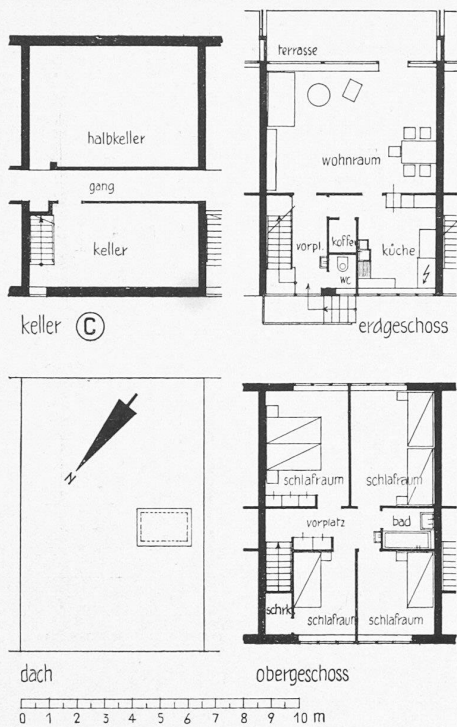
Grundrisse von Typ C. — 1 : 250.
